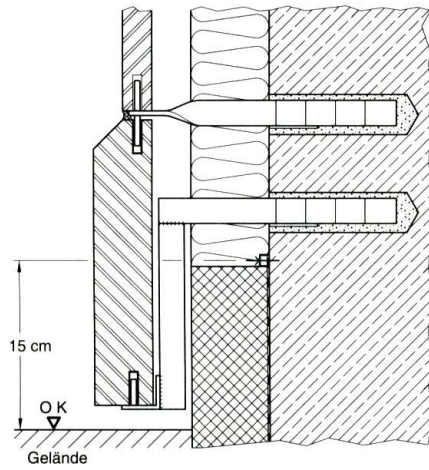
Regeldetail zur Ausführung einer Fuge zur Geländeoberfläche bei Sockelplatten
